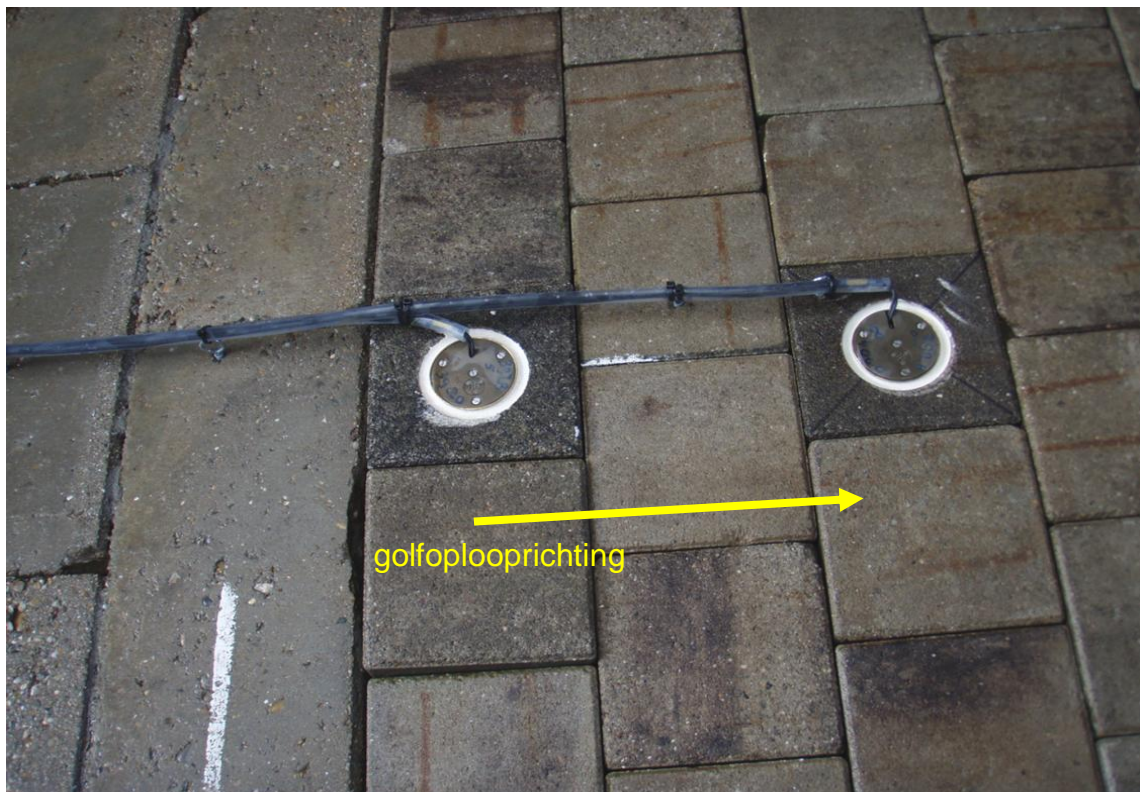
Modelopstelling (bovenaanzicht DRO's in testsectie blokken)
